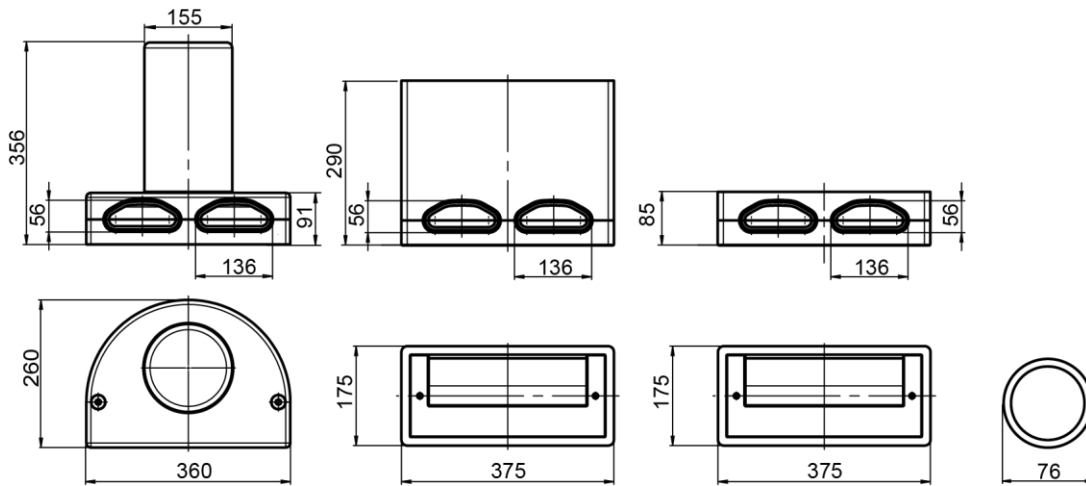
Abmessungen Abluftelement, Zuluftelement, Zuluftelement Wand und Rundrohr 75 (von links nach rechts; alle Maße in mm)
